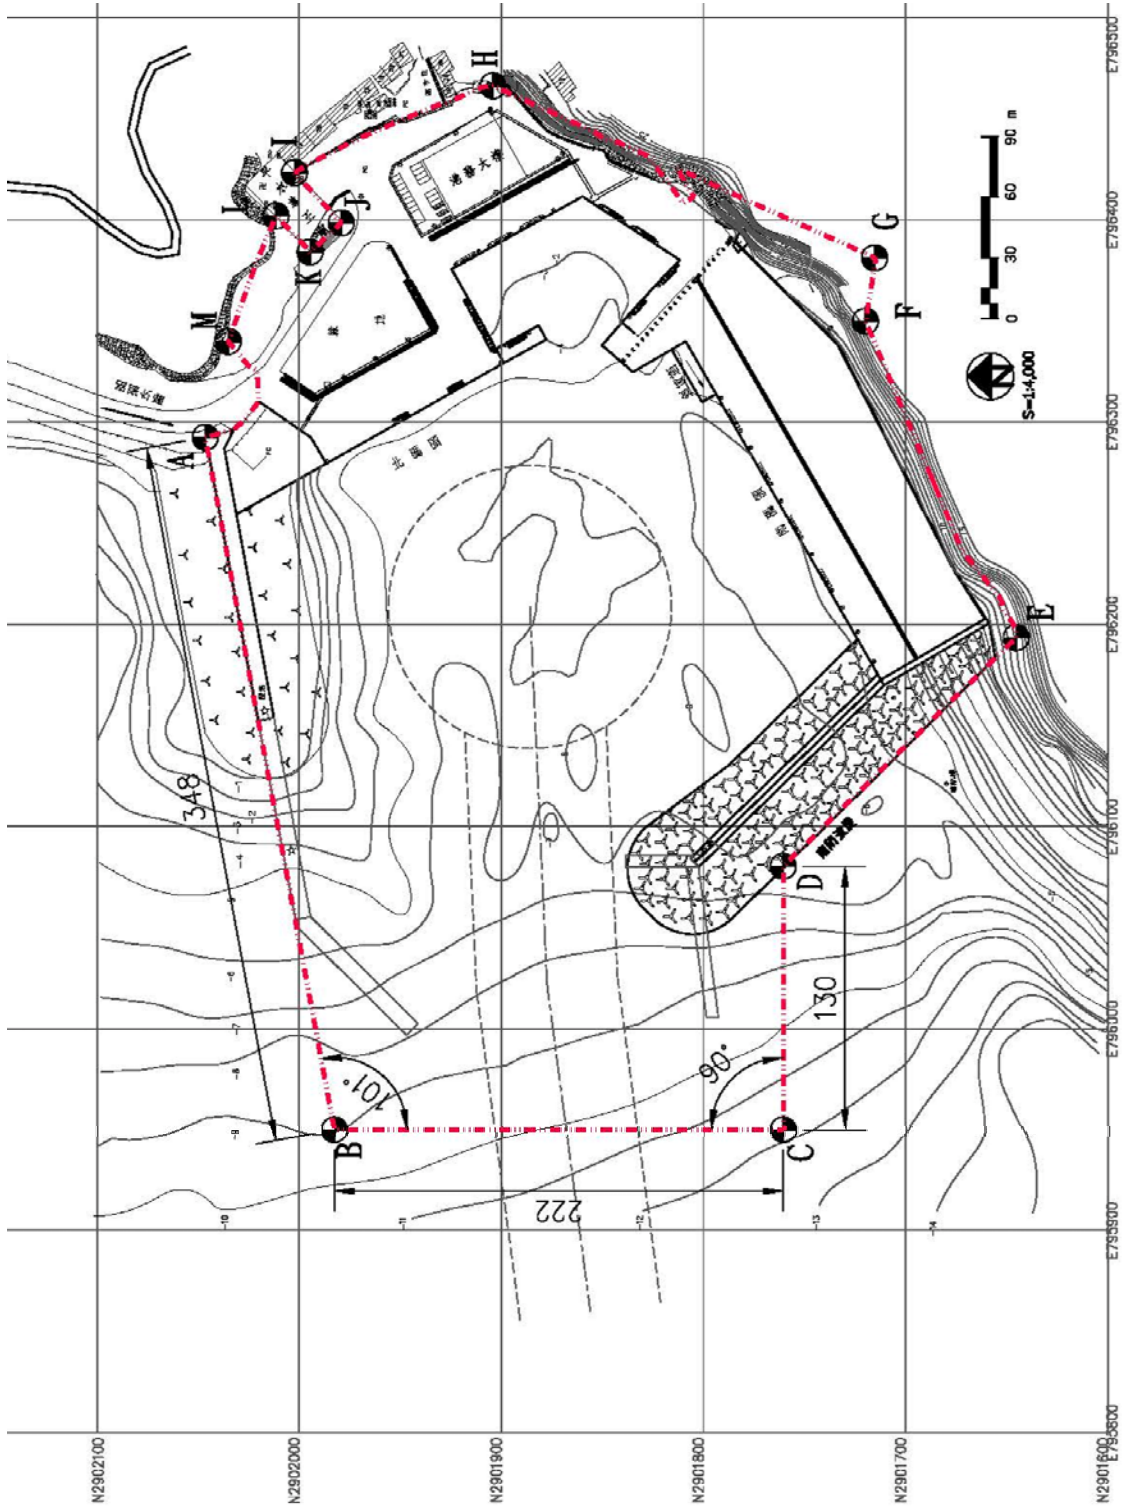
北竿白沙碼頭商港區域平面圖
